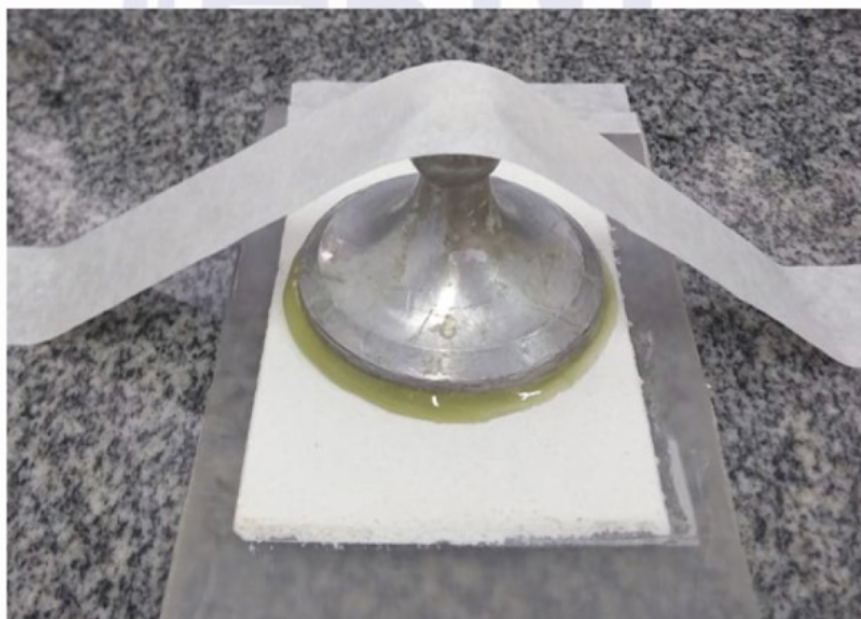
Conjunto placa de policarbonato e pastilha fixado sem remoção de excesso de cola
